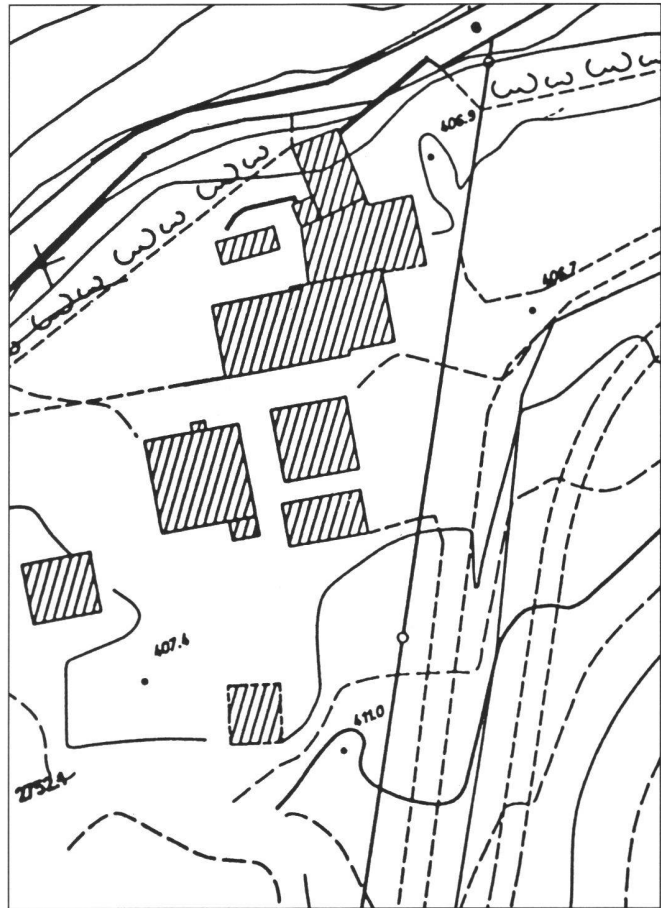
Plan CFF au 1:500 pour l'étude de «rail 2000».
